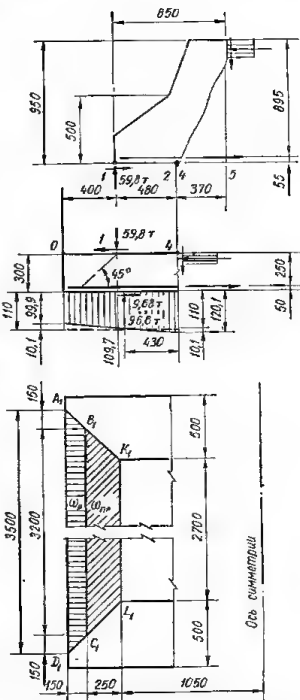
К расчету двухслойного фундамента по ширине.
